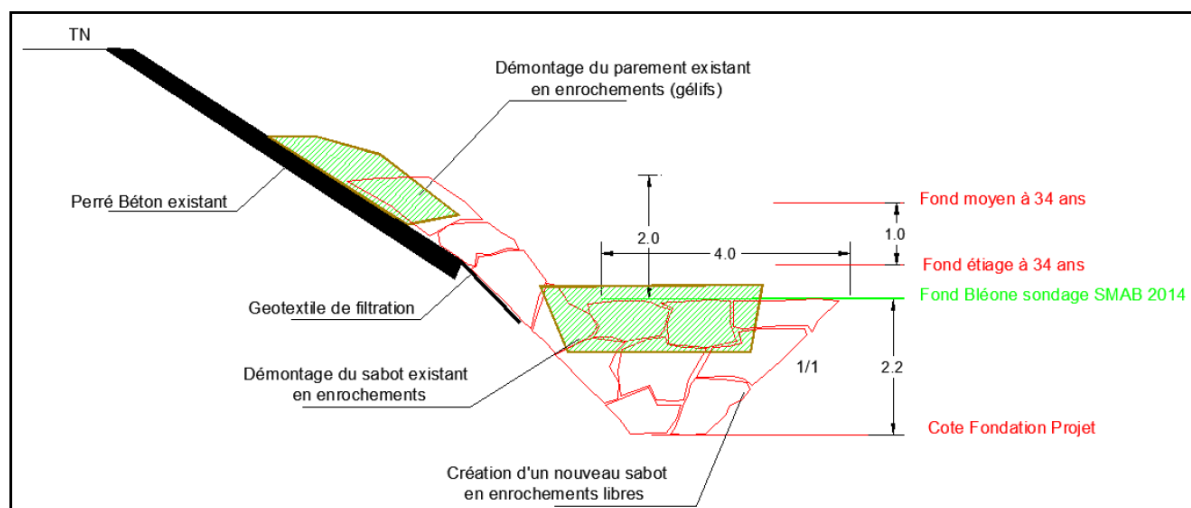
Coupe type de la reprise de la digue du plan d'eau de Gaubert
